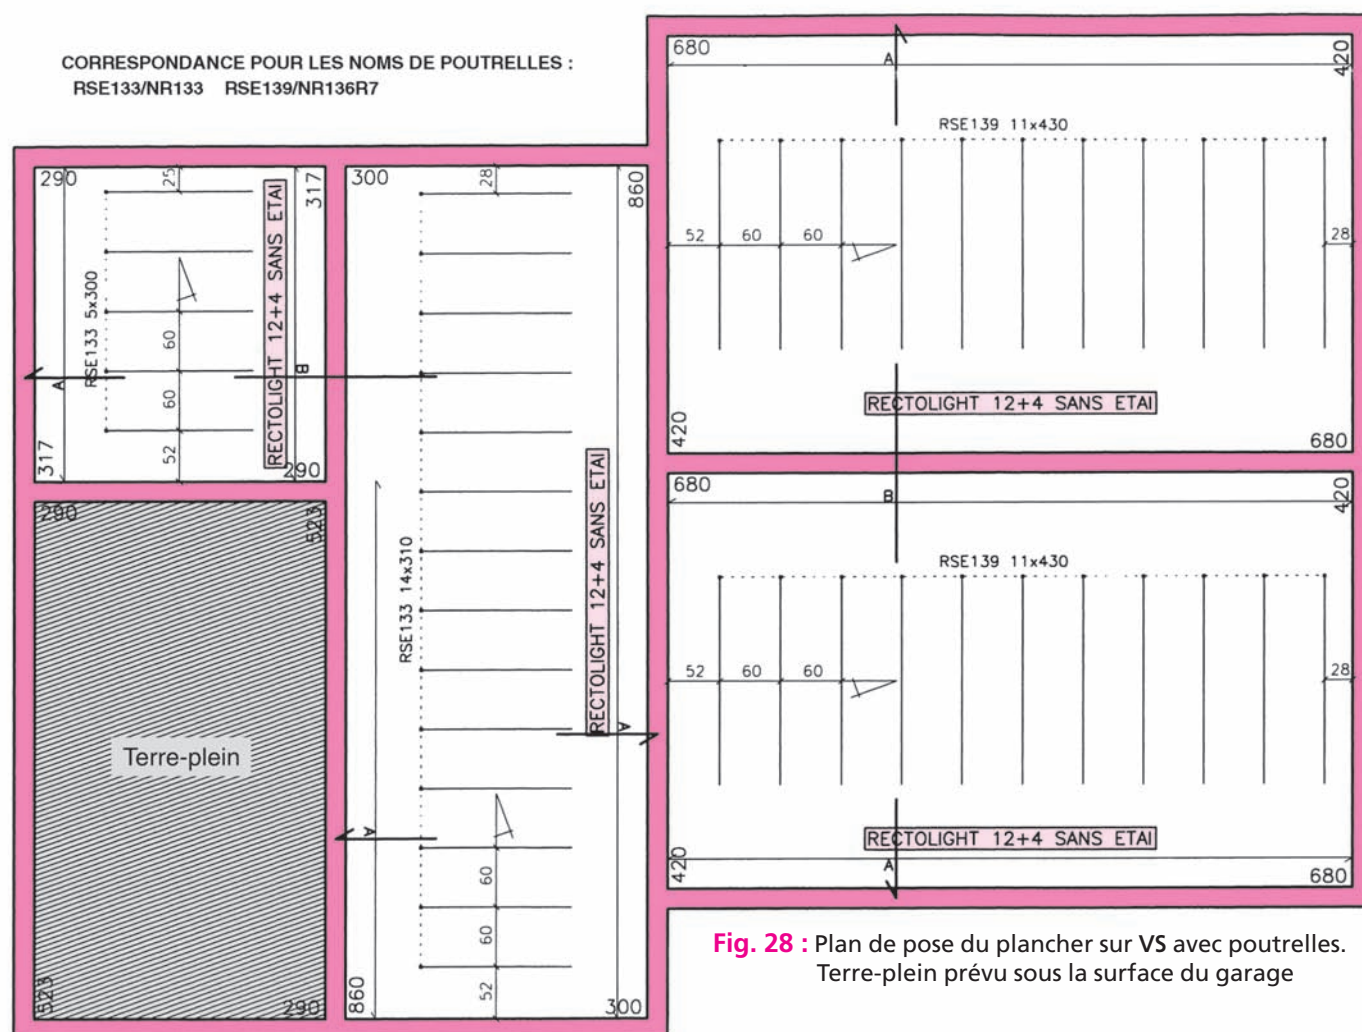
Plan de pose du plancher sur VS avec poutrelles.
